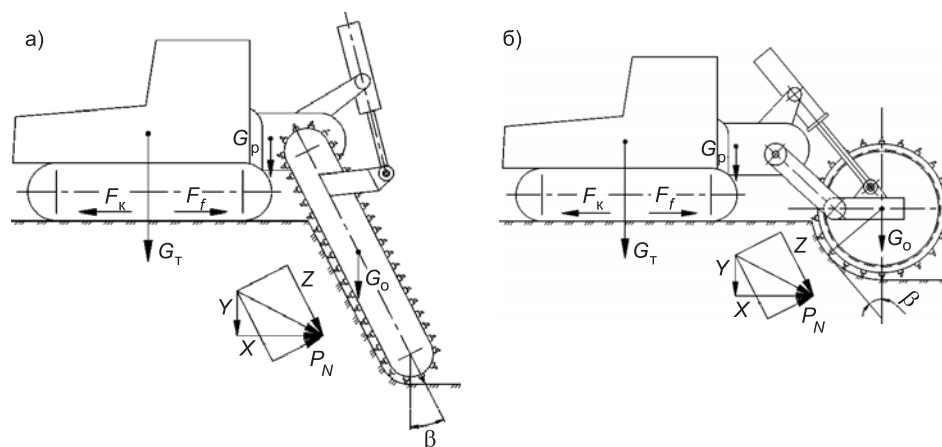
Схема сил, действующих на цепной (а), фрезерно-роторный (б) траншеекопатели
